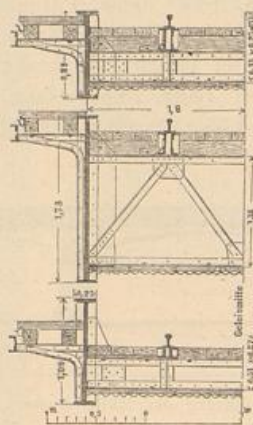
46. Details der Müllerstrassen-Unterführung.
